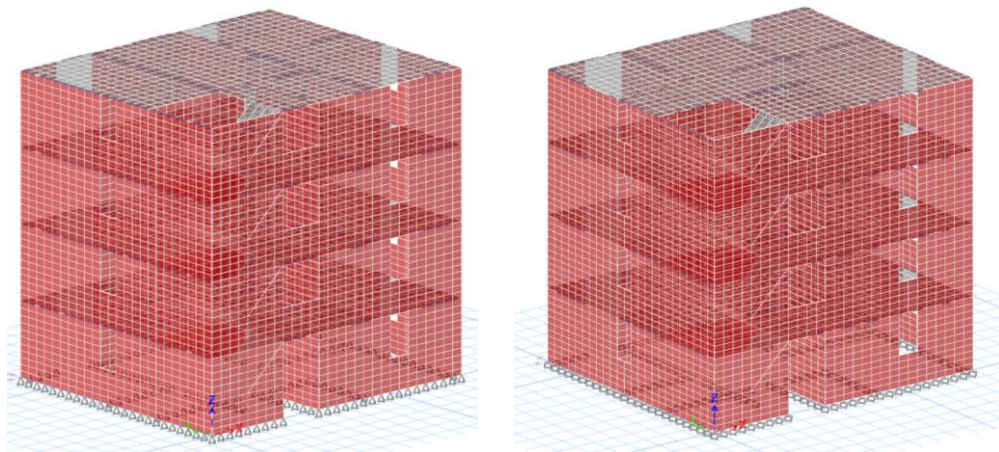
Modelo 3 con discretización alta de los muros de mampostería y apoyos articulado (3A) y empotrado (3B) respectivamente.
